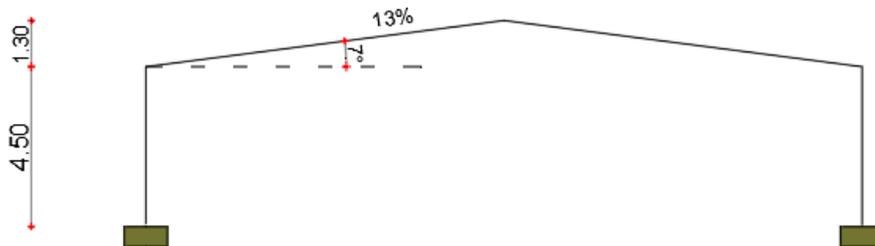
Vista en elevación de la nave industrial. Fuente: Los autores.
